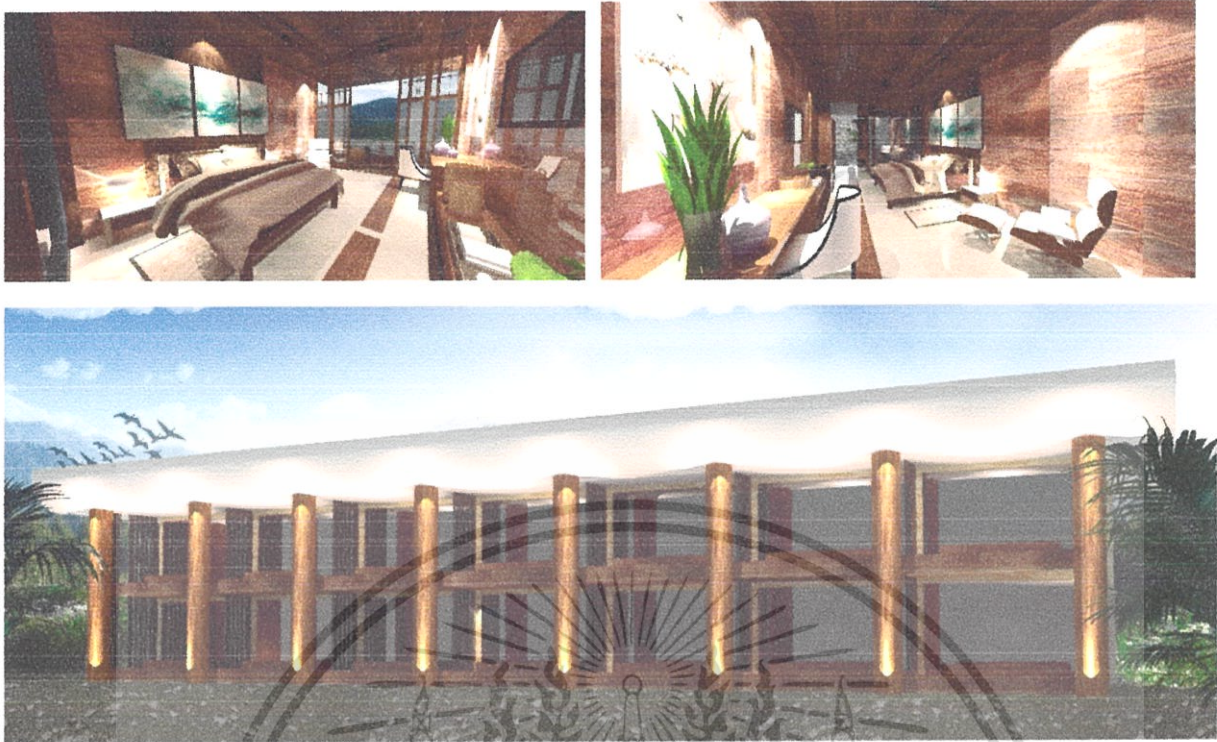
แสดงภาพsection ของ Hotel type
